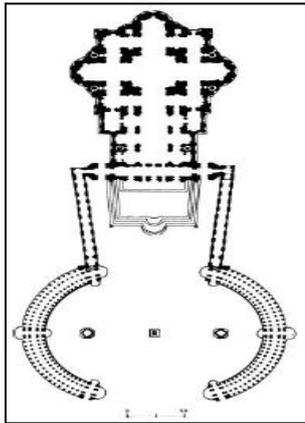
Plan de la place St-Pierre, à Rome (1574 –1656).
